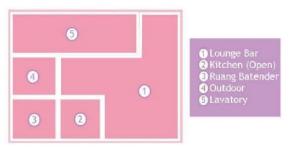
Blok Plan Kelompok Ruang - Lobby (Sumber : Analisis, 2020)
